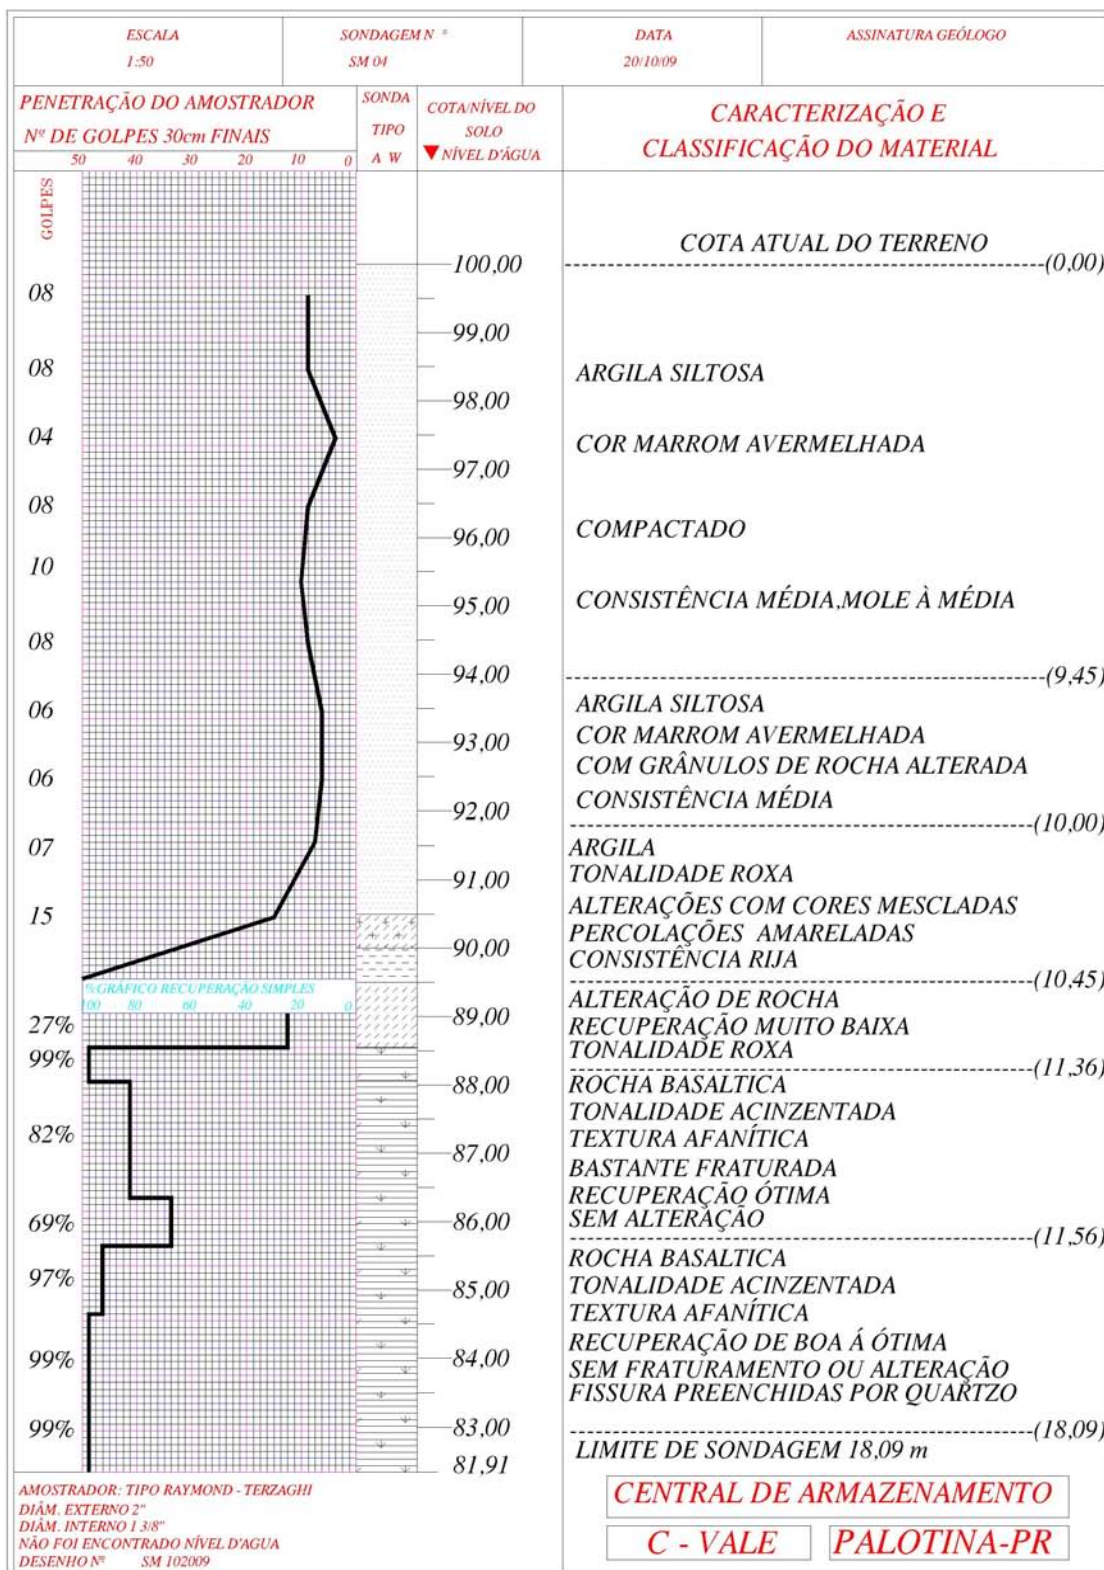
Perfil Sondagem Mista (SM) furo 04.
